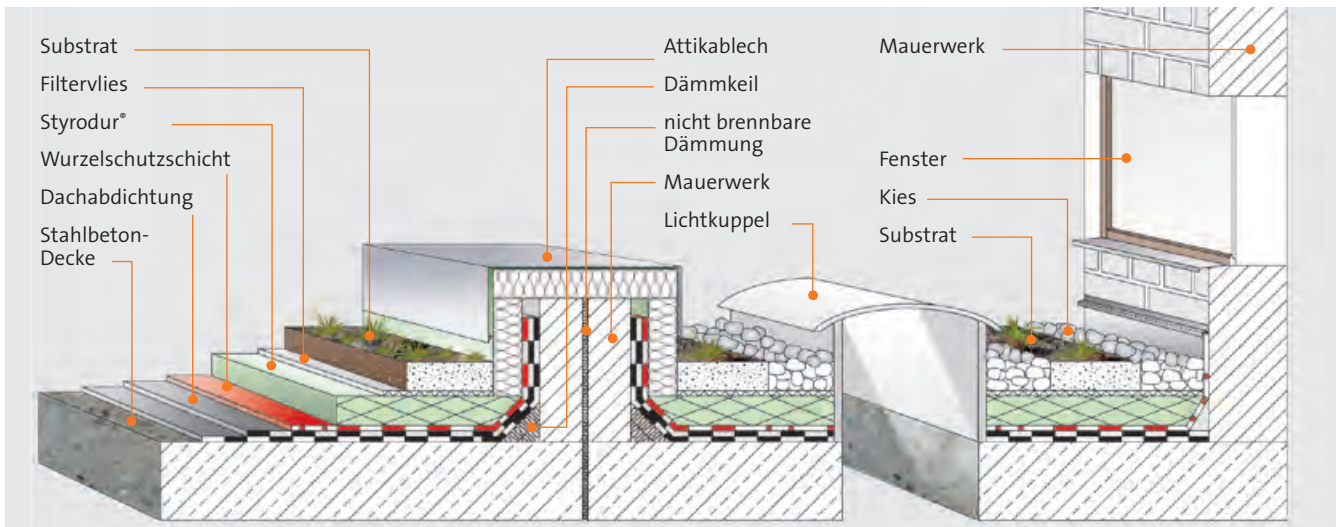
Brandabschnitt eines Flachdaches mit Extensivbegrünung.
